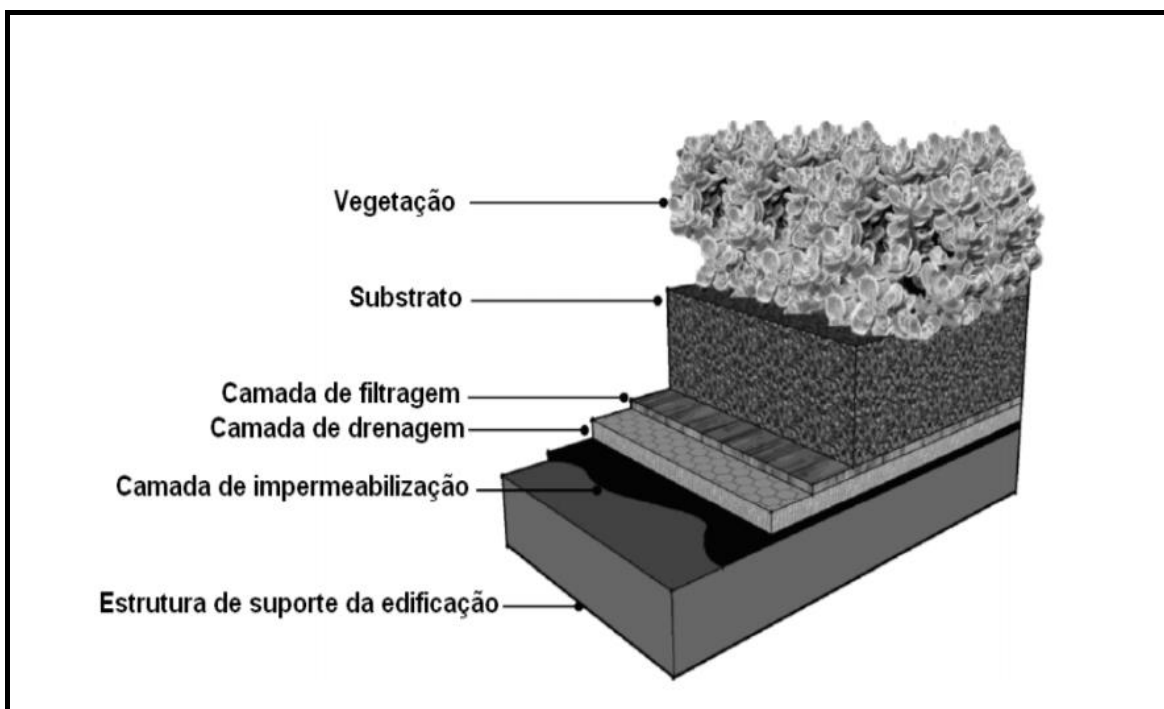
Esquema ilustrado das camadas de um telhado verde básico. Fonte: Adaptado de Martin (2008)
